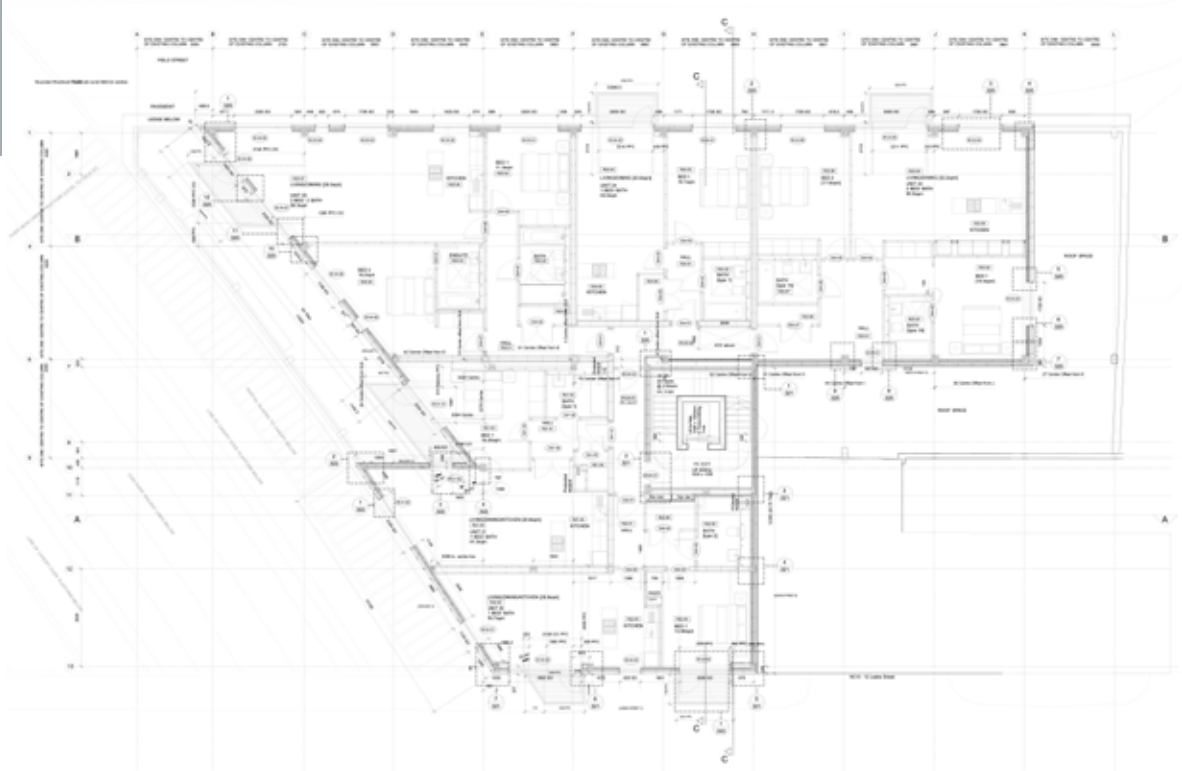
Grundriss 2.OG © Project Orange
